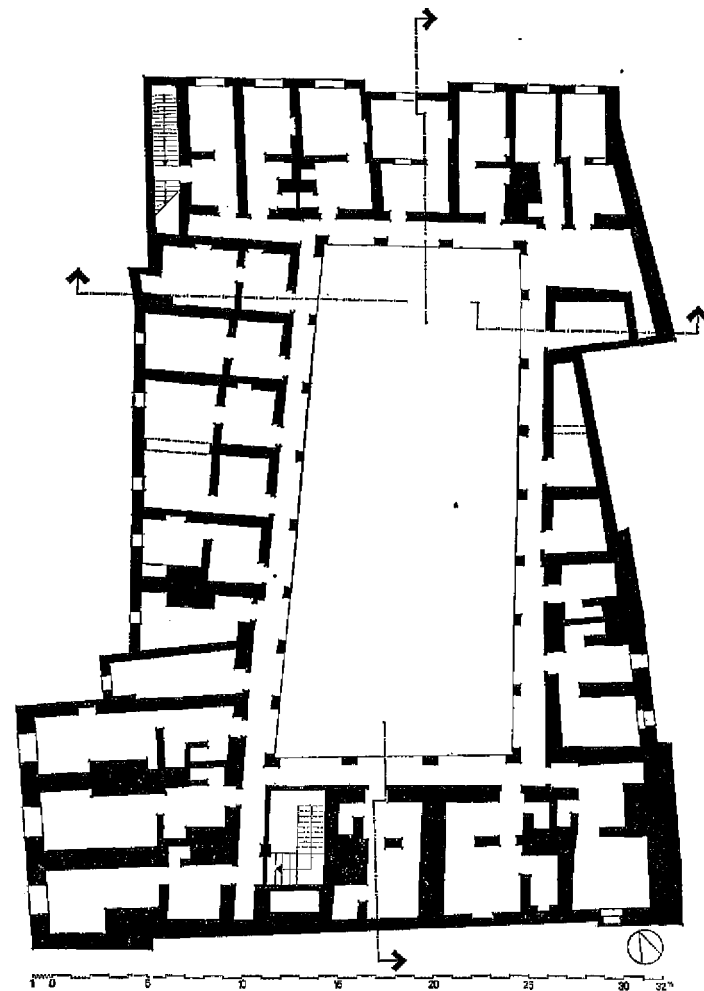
Kairo, Wakalat al-Bazar'a, Grundriß — erstes Obergeschoß
